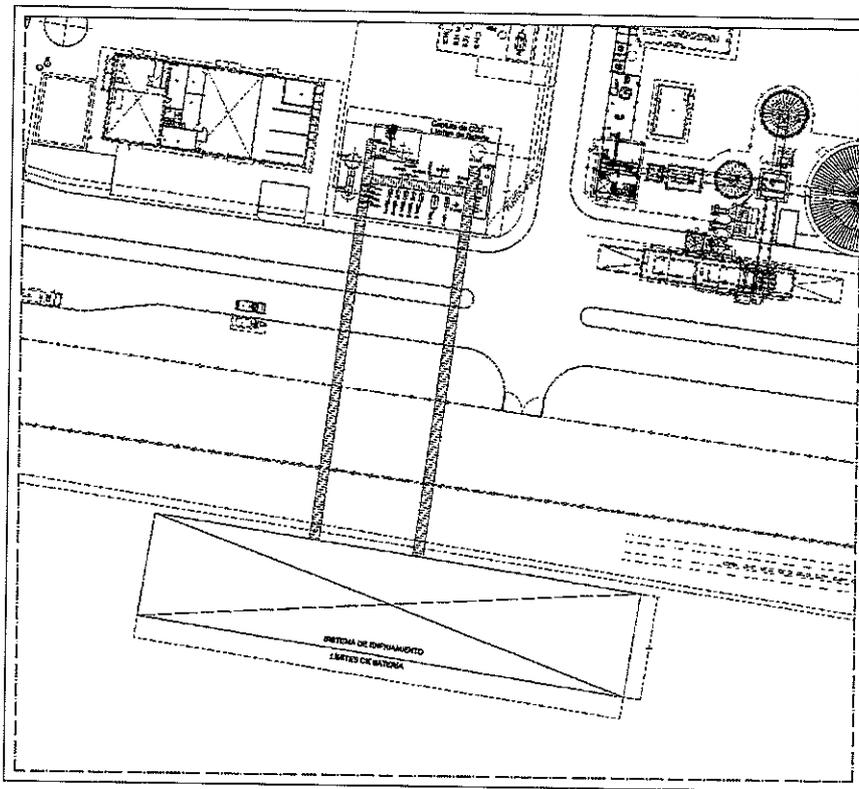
Planta de Captura de CO2 en ALUR Paysandú
